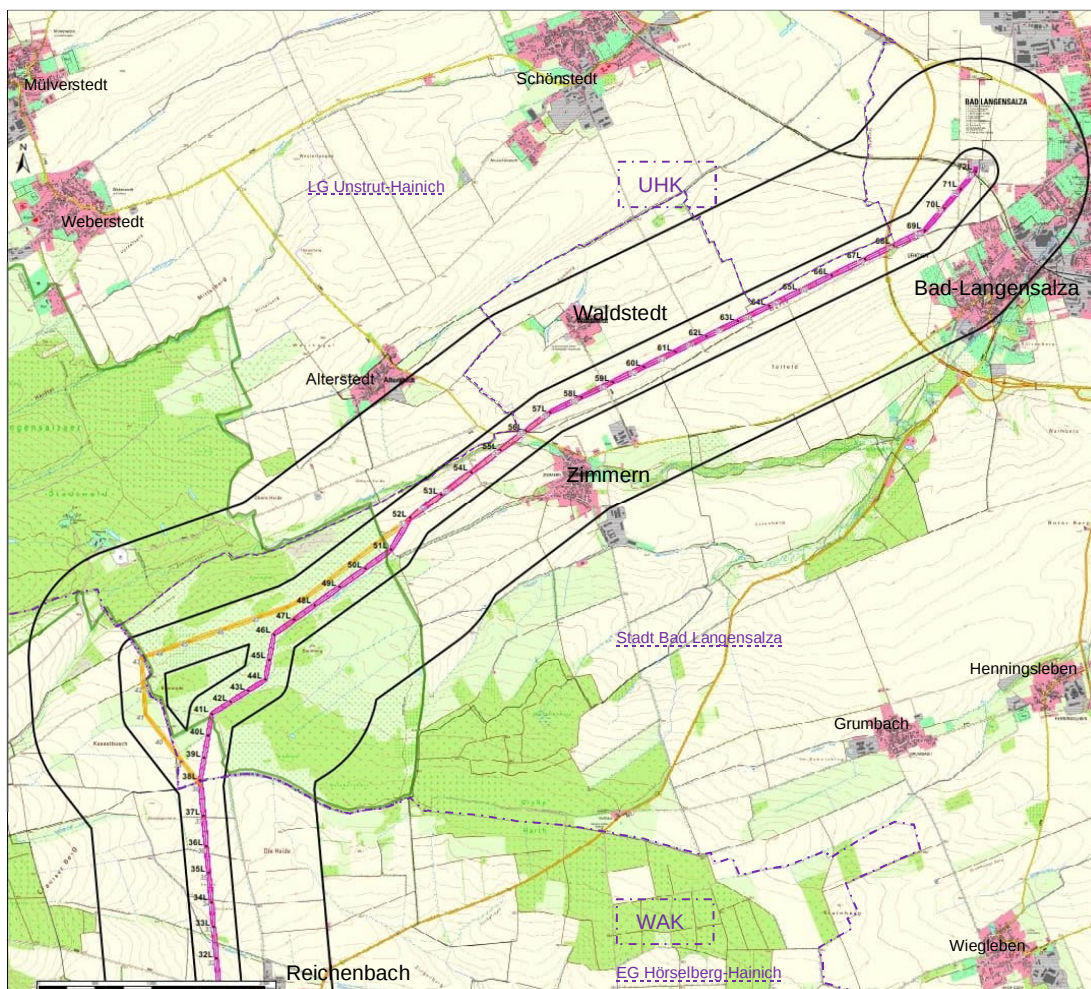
Übersicht Lageplan Abschnitt NLP Hainich bis Umspannwerk Bad Langensalza mit Trassenfreihaltebereich, (Violett), Rückbautrasse (Orange), Betrachtungsraum 400 m und 1.000 m Korridor
